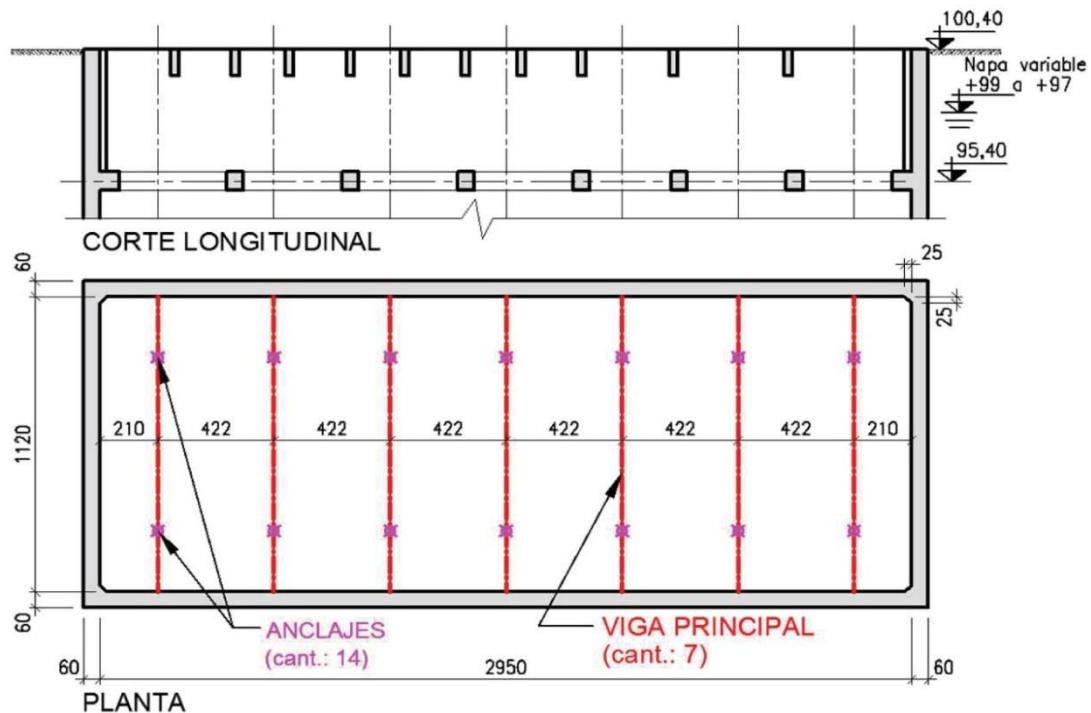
Propuesta Nº 4: Posición vigas principales y anclajes activos postesados
